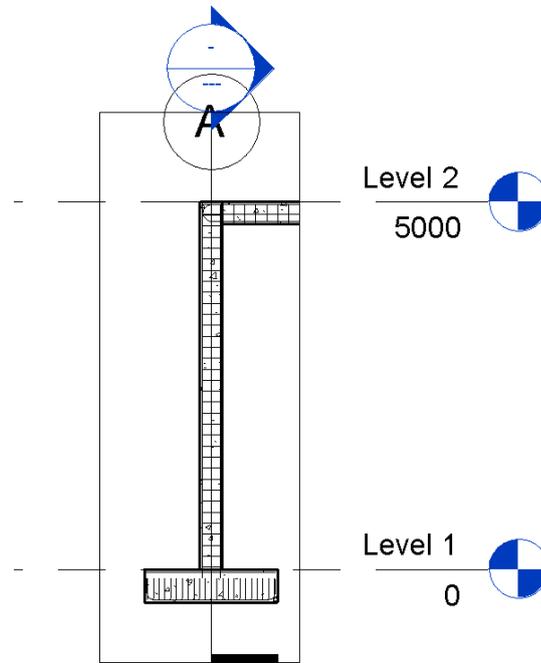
Exemplo de corte de pilar e fundação do modelo criado pela autora, utilizando o programa Revit.
